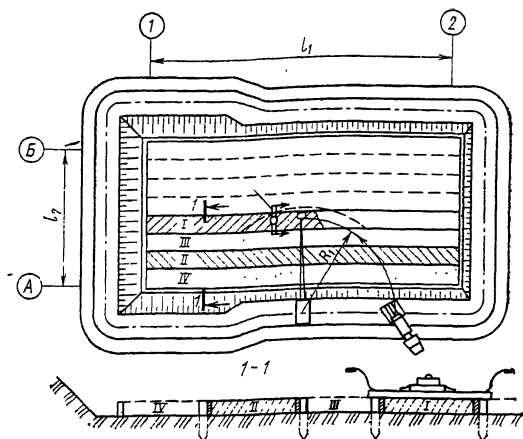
Порядок укладки бетонной смеси при устройстве бетонной подготовки и железобетонного дна бассейна
